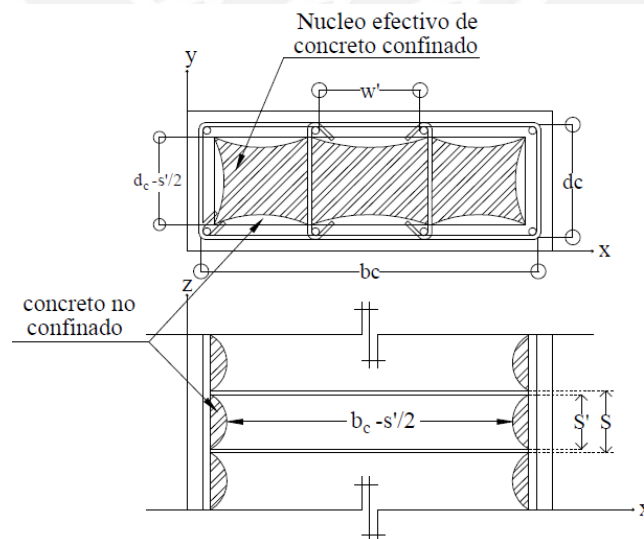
Núcleo efectivo de concreto confinado para una sección rectangular [32].
